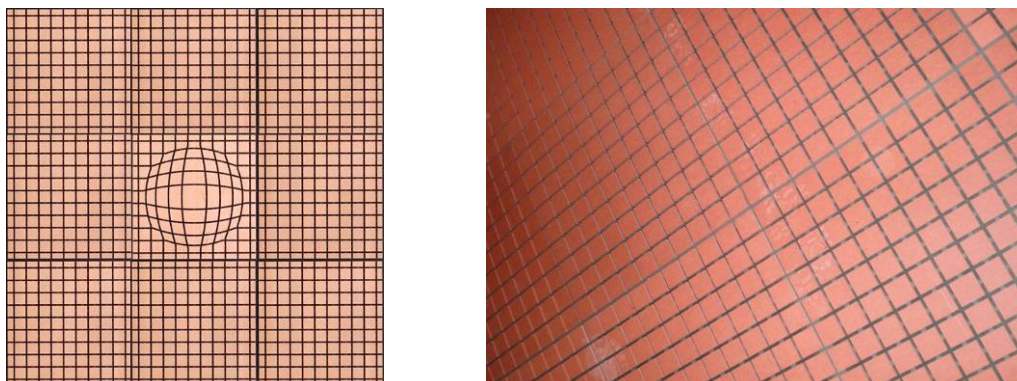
Exemplo de aplicação dos painéis *SQR-DECO*.
